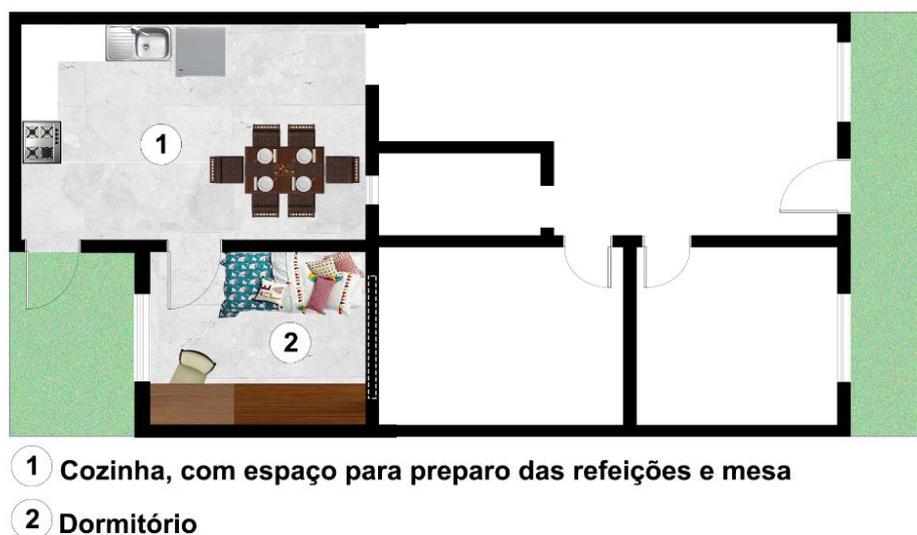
Planta baixa do uso da expansão na quinta proposição. Fonte: Autor, 2023.
